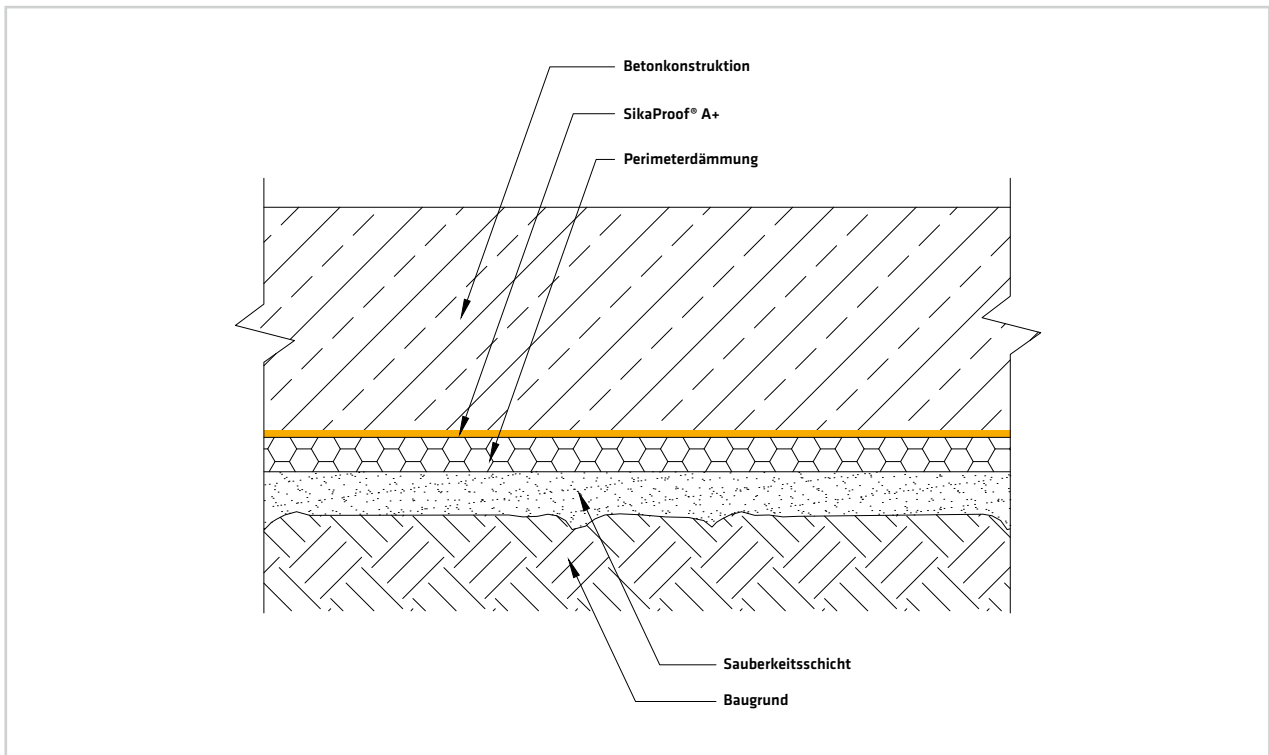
Verlegung auf Sauberkeitsschicht
